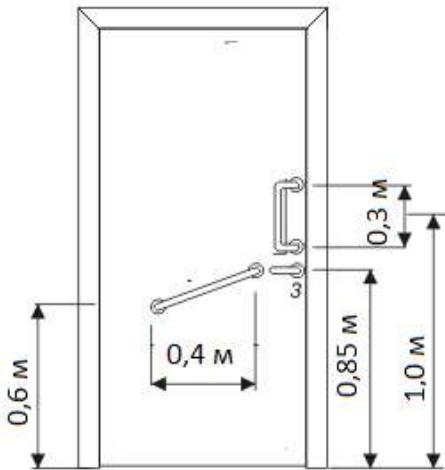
Расположение ручки и задвижки на двери
